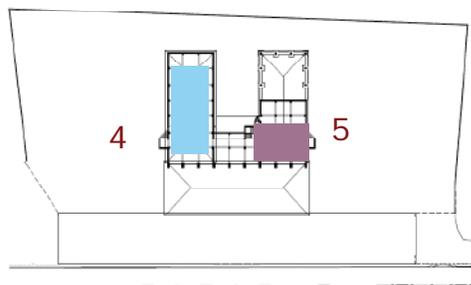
PLANTA ESQUEMÁTICA SUBTERRÁNEO: 4 y 5 indican los accesos desde el nivel de la calle.
